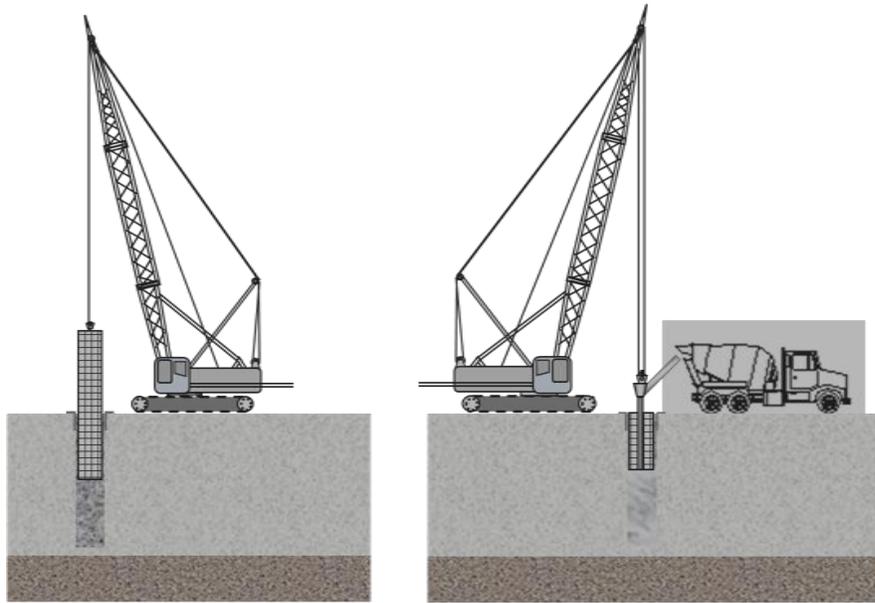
; Colocación de acero y colado del muro Milán.
